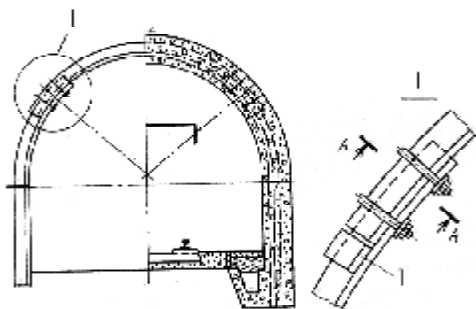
Металобетонне кріплення із спецпрофілю:
